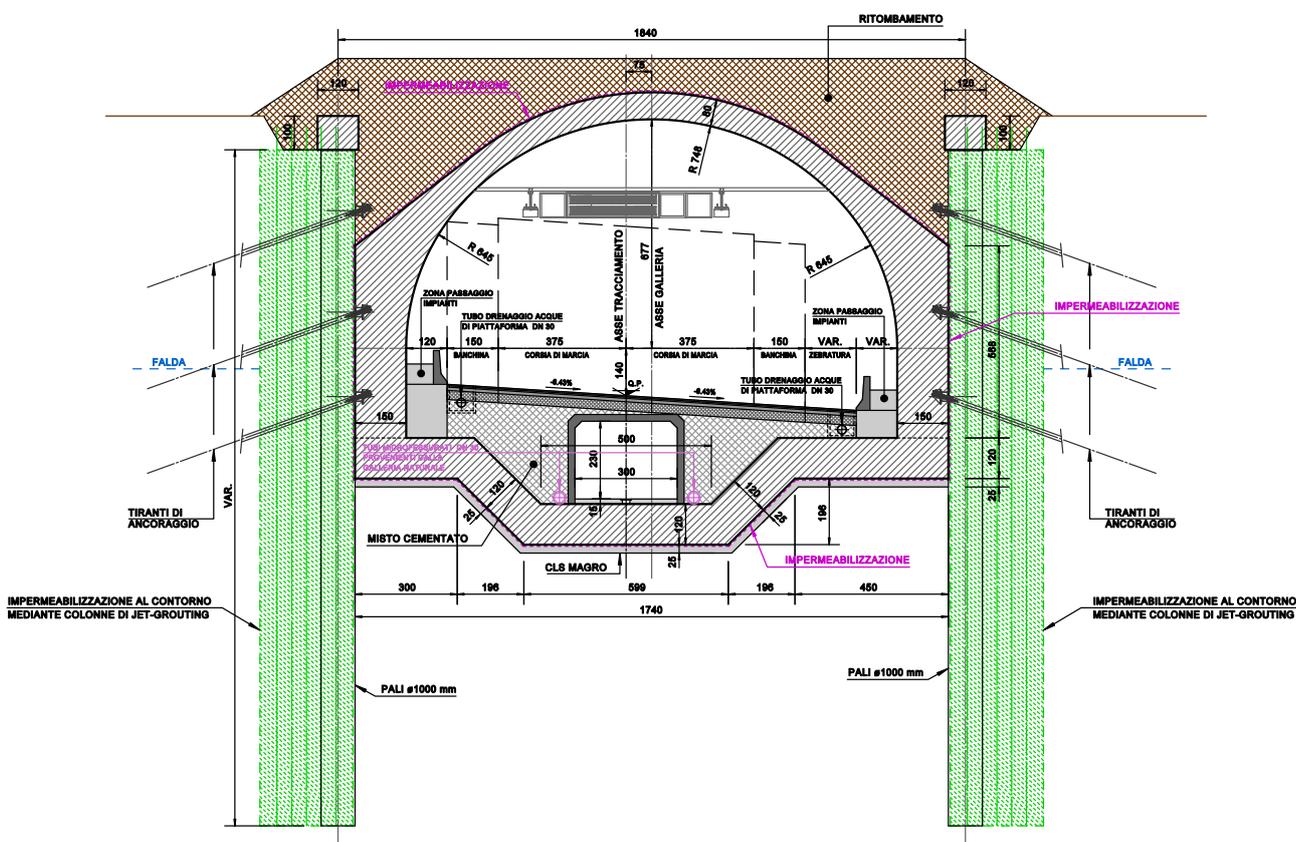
Galleria Artificiale SUD – Sezione tipo circolare
